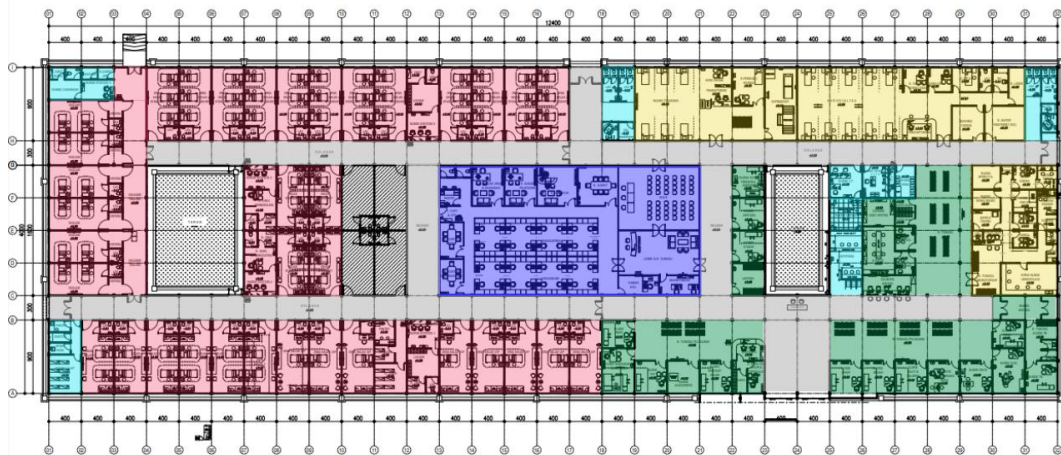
10 Denah Lantai 2 Gedung A RS Samsoe Hidajat
